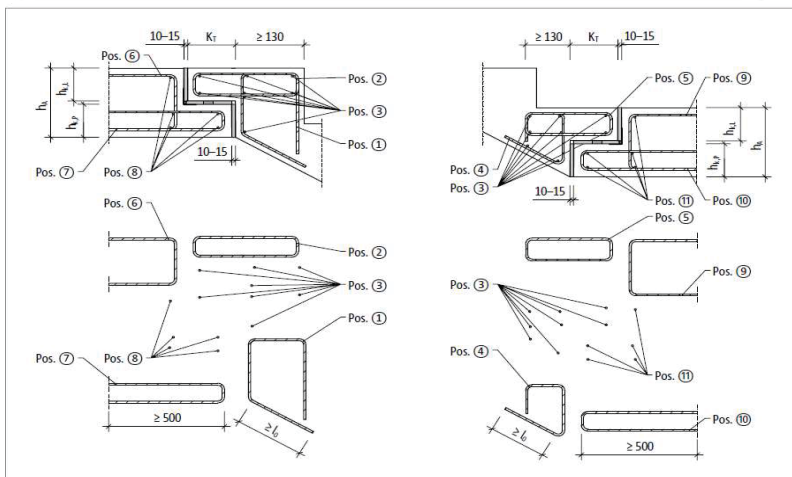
Schöck Tronsole® Typ F: Bauseitige Bewehrung bei bündigem Anschluss
